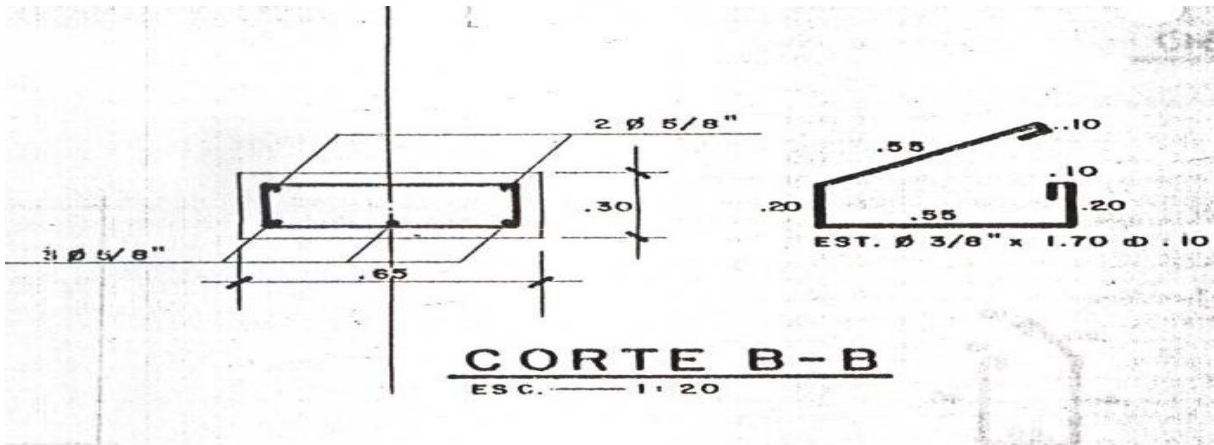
Corte B-B del detalle de viga VR-3. Modulo de Barrio.
